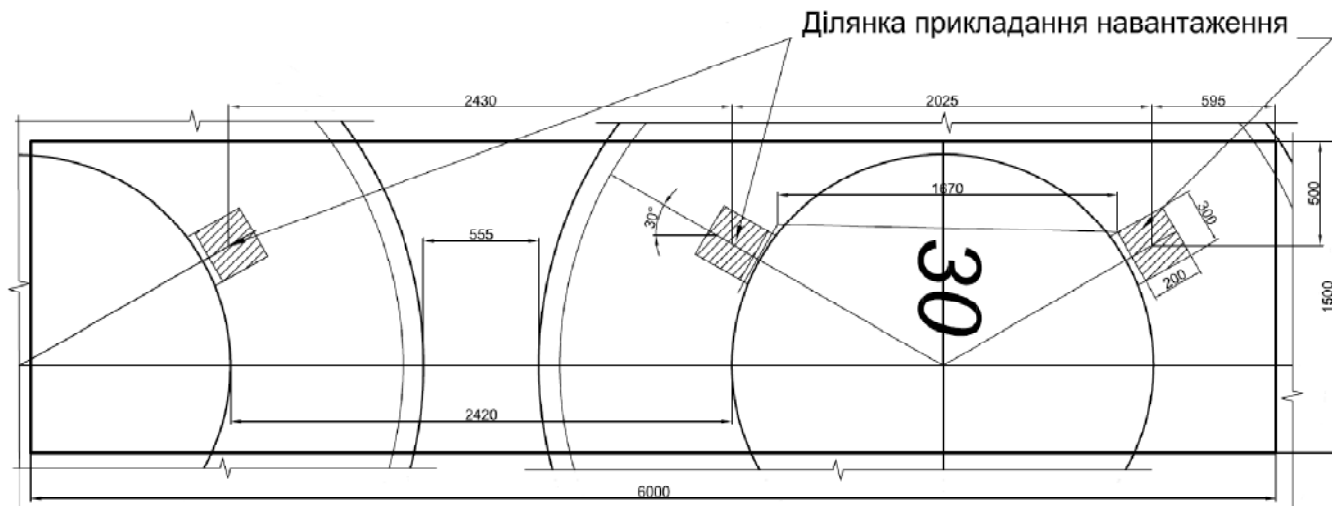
Схема навантаження від обладнання на плиту перекриття
